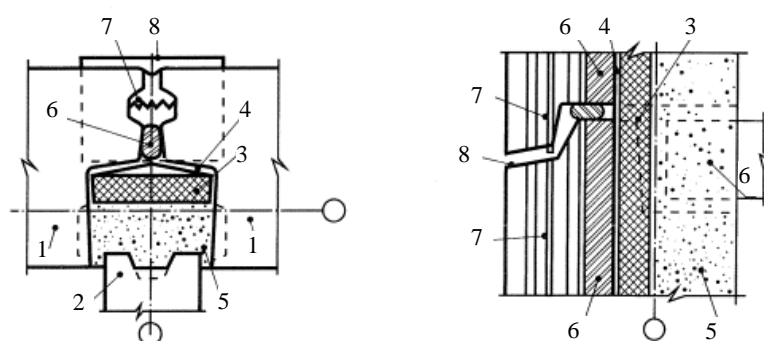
Схема герметизації вертикального і горизонтального стику відкритого типу: 1 – зовнішня стінна панель; 2 – внутрішня стінна панель; 3 – теплоізоляційний вкладень; 4 – вітрозахисна обклеювальна ізоляція; 5 – замонолічувальний бетон колодязного стику; 6 – ущільнювальна прокладка; 7 – водовідбійний екран; 8 – водовідвідний фартух
